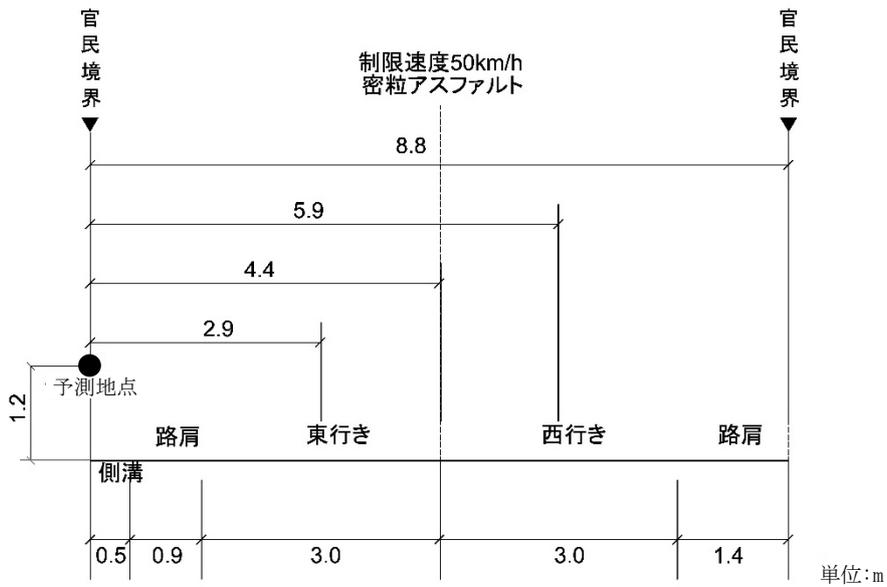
予測断面図 (牧 県道 16 号大津信楽線)
